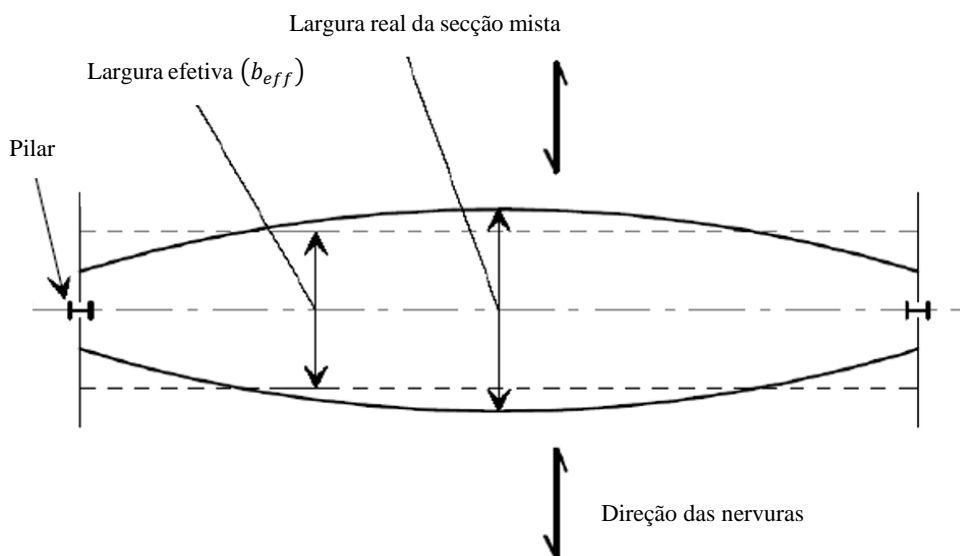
Distribuição das tensões de compressão na laje colaborante ao longo do comprimento da viga mista.
